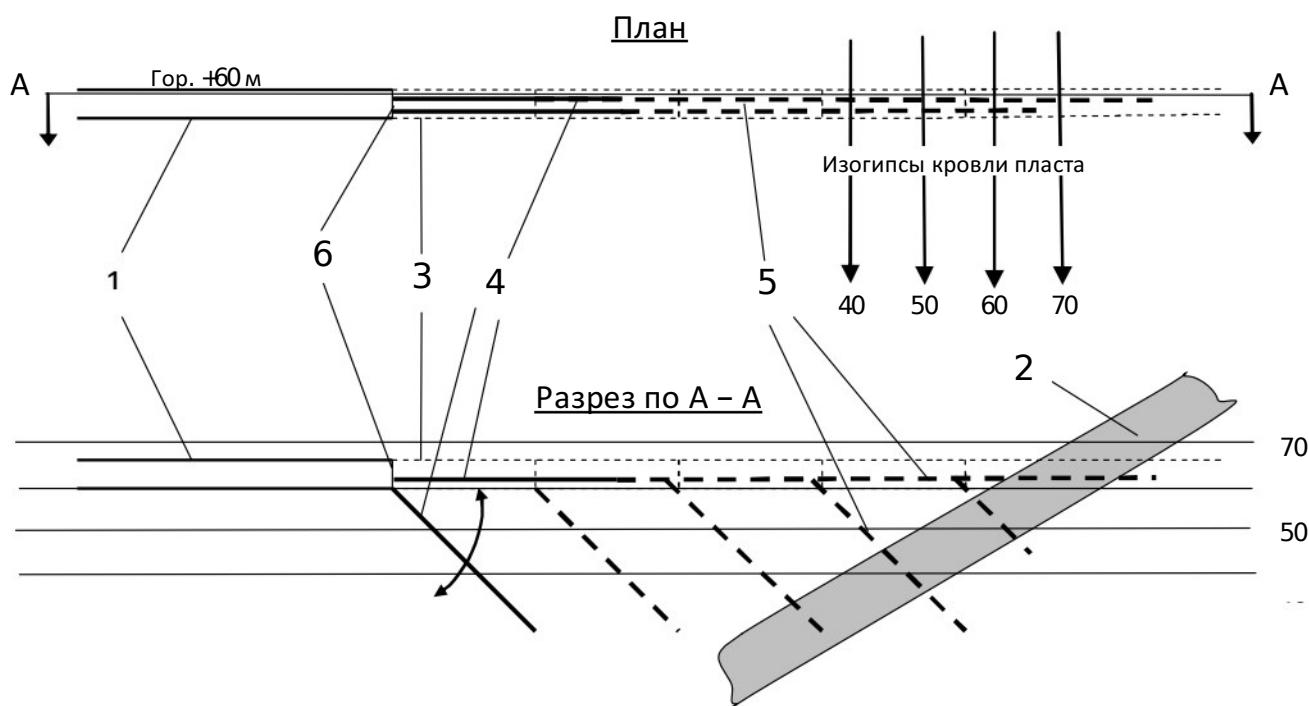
Схема бурения разведочных скважин для уточнения положения пласта относительно вскрывающей выработки, приближающейся к пласту со стороны кровли нормально к его простиранию:
